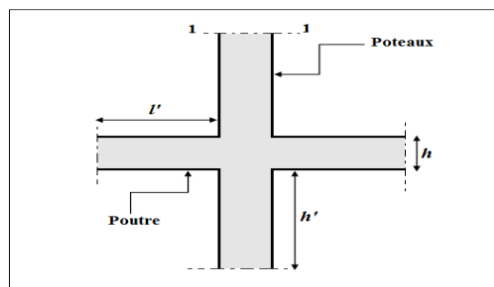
Zone nodale (nœud poutre-poteaux)
